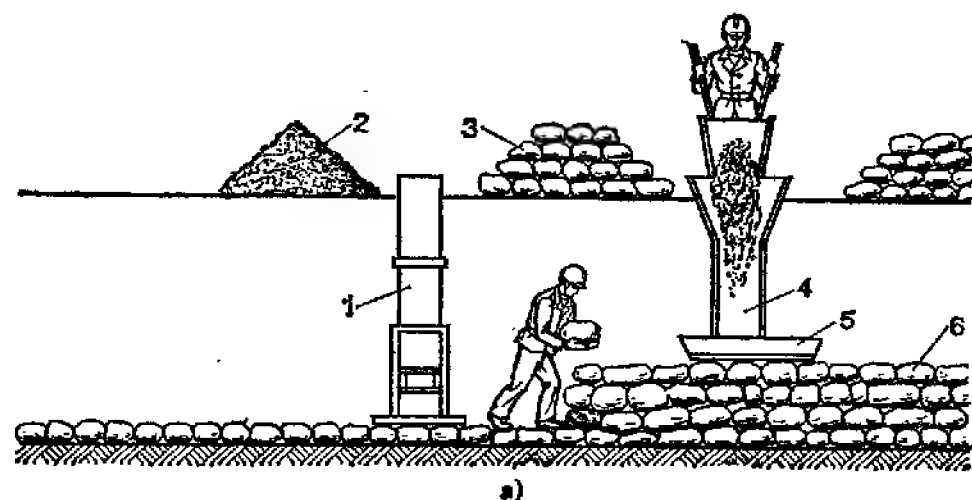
Организация рабочего места при бутовой кладке фундаментов в траншеях и котлованах глубиной более 1,25 м:
